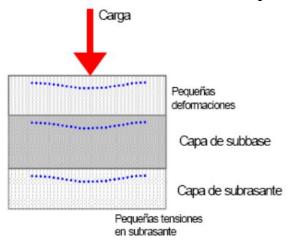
Sección transversal de deformaciones de un pavimento flexible
